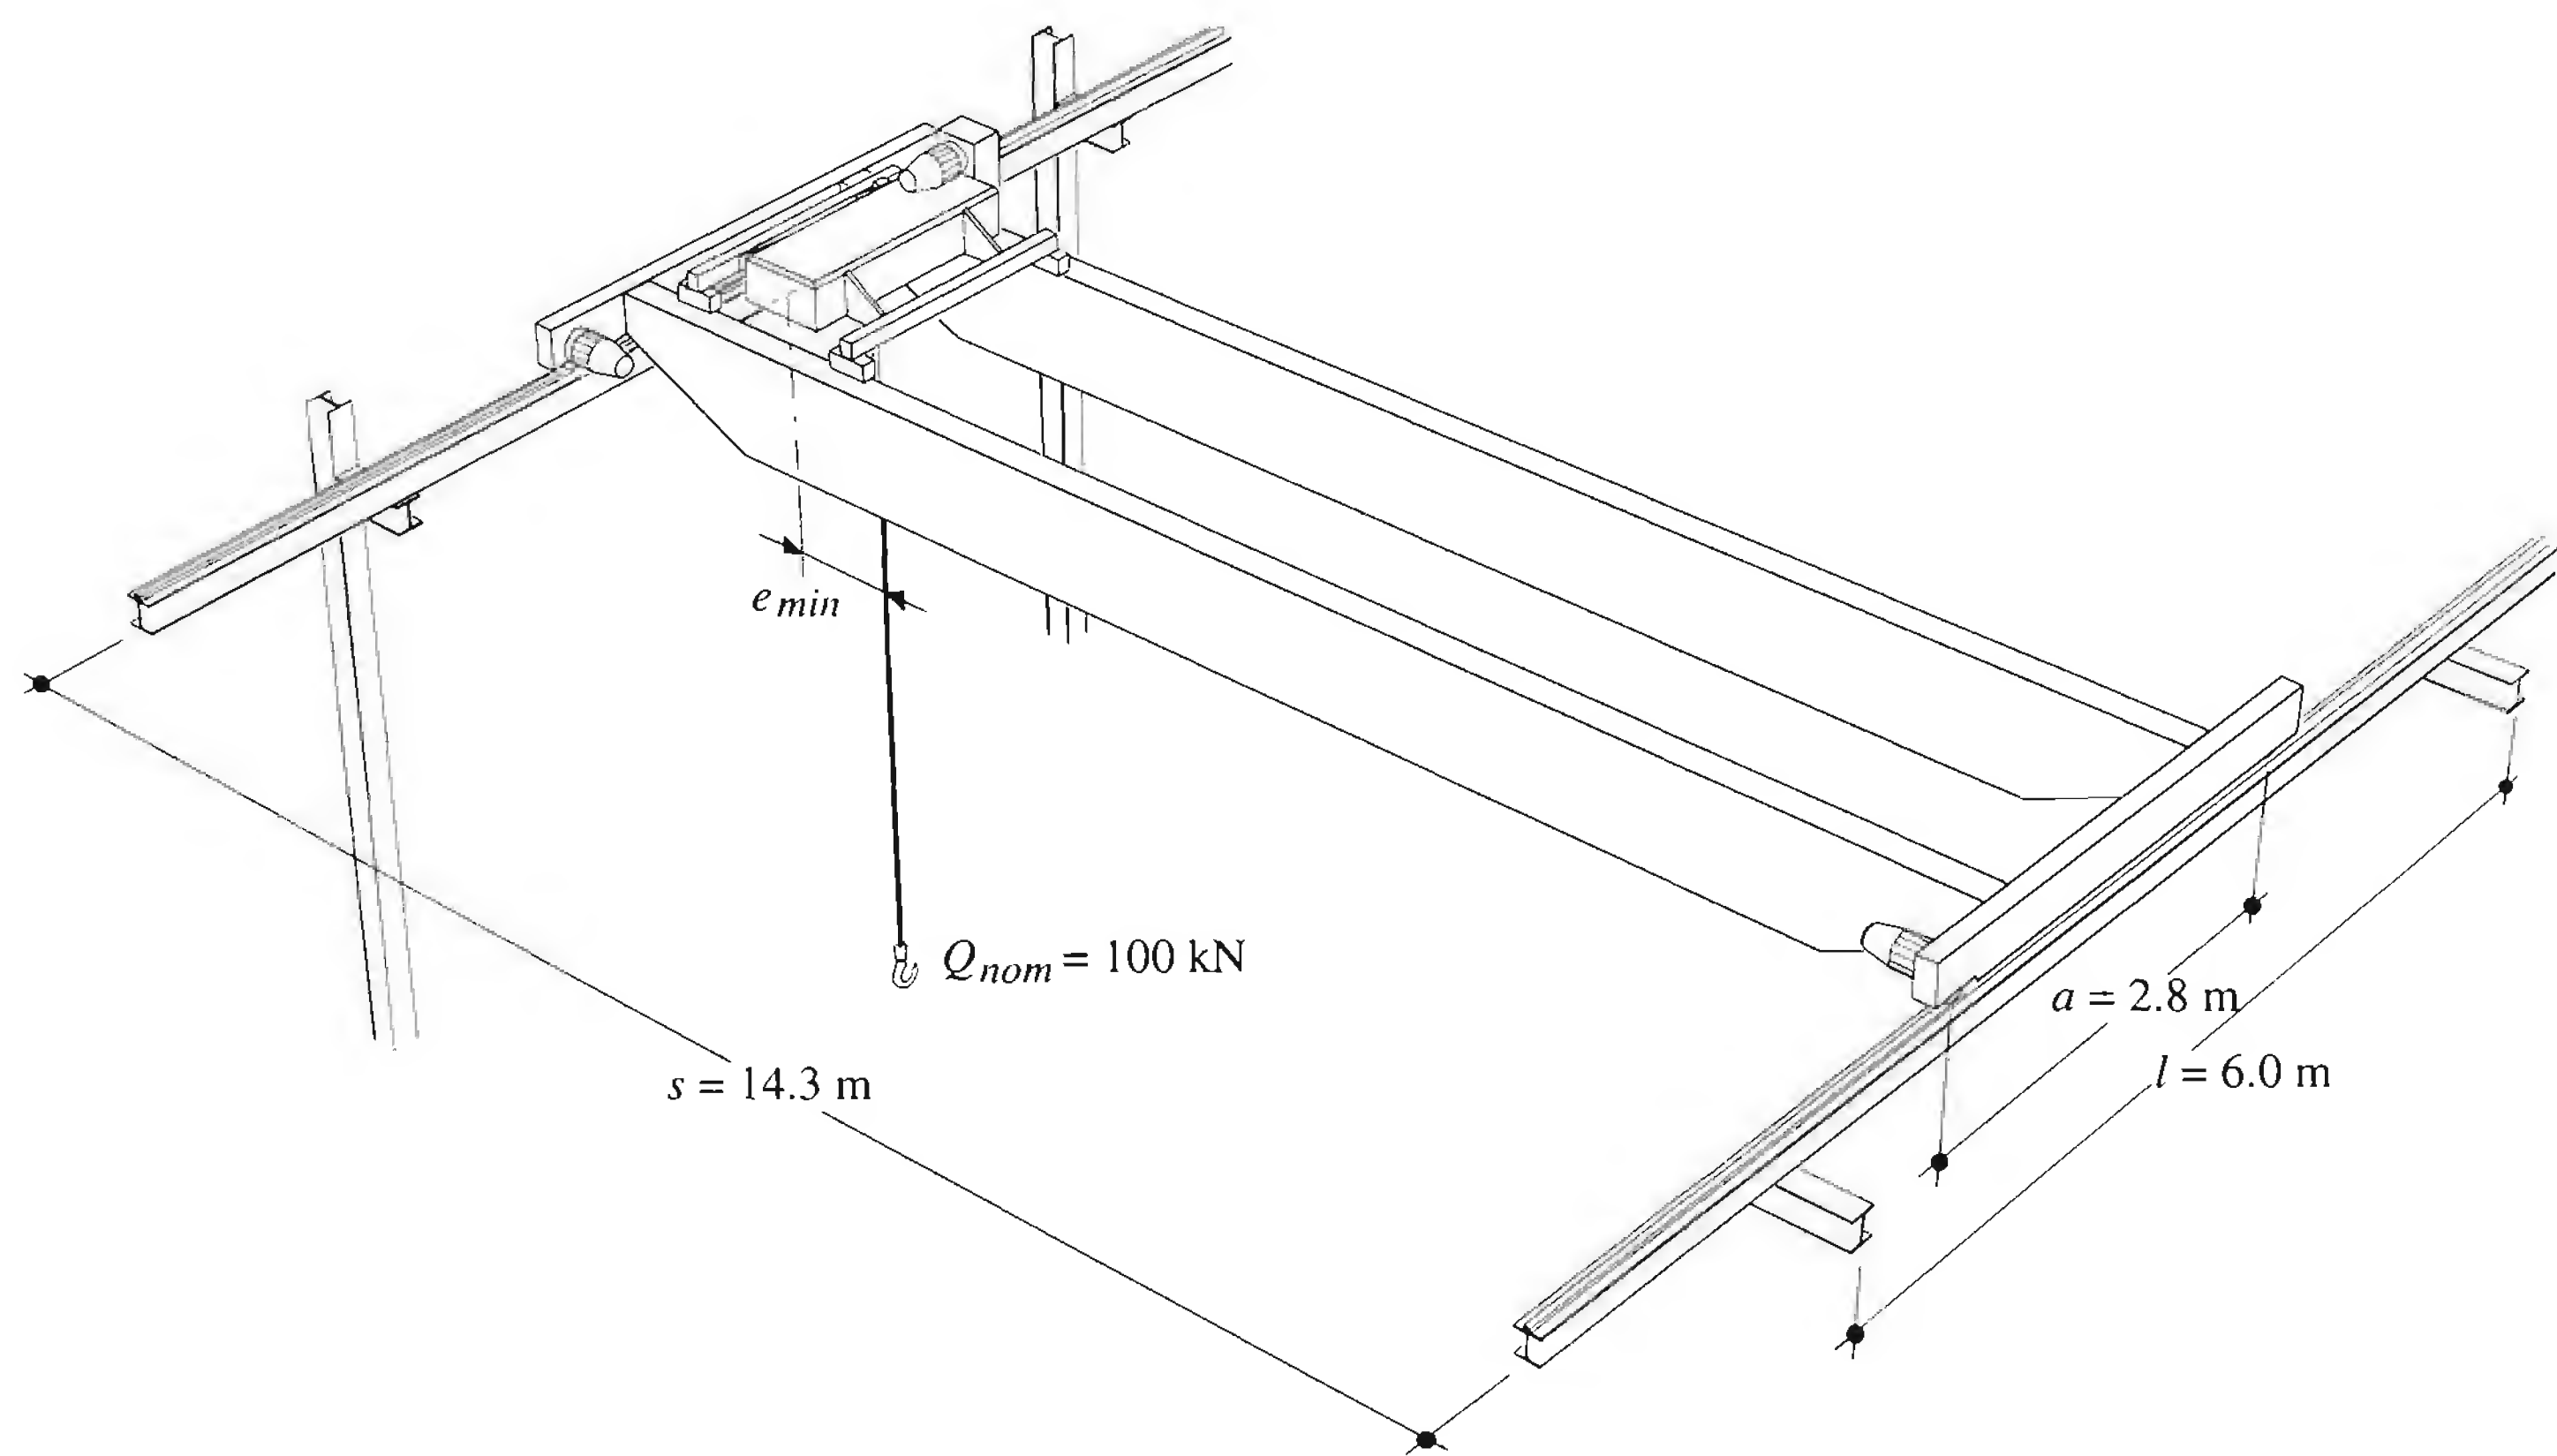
Voie de roulement à dimensionner et à vérifier.
